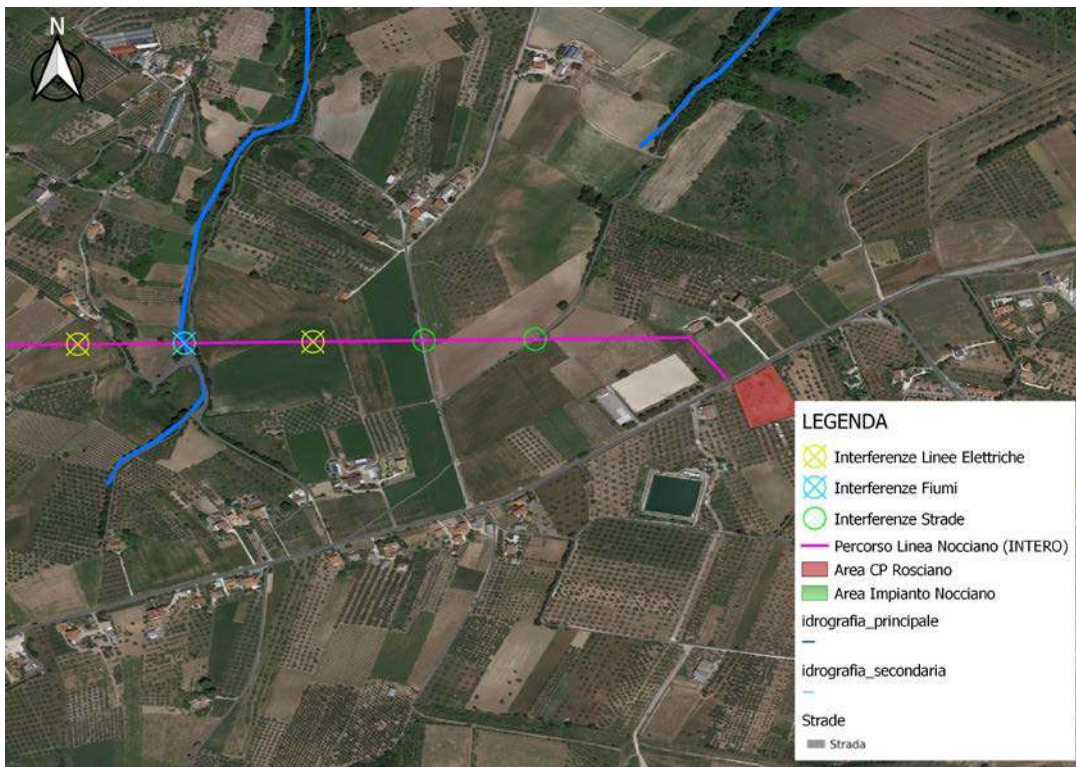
PLANIMETRIA DELLE INTERFERENZE N. 4 DI 4
